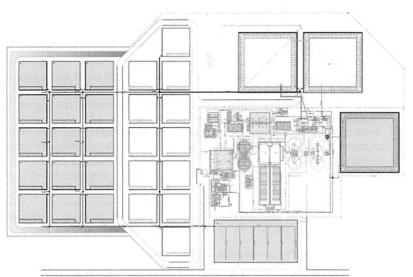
Planimetria di progetto. Presidio depurativo di Cavallino - Lizzanello.
